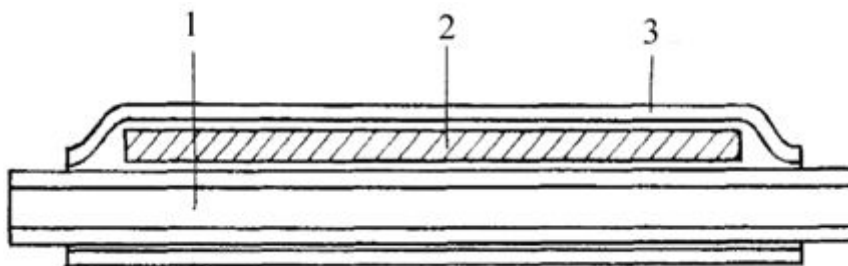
Комплект деталей для захисту місця зварки:
